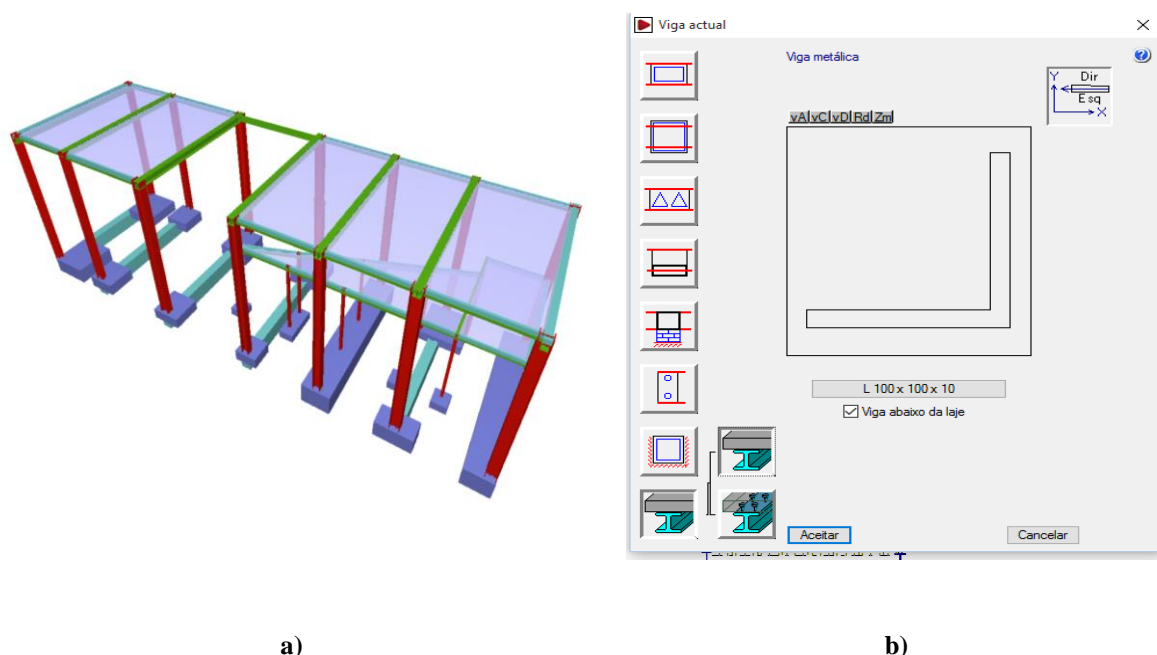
a) Vigas metálicas ao nível do Piso 1; b) Cantoneira perimetral (Fonte: Cypecad, 2015)
